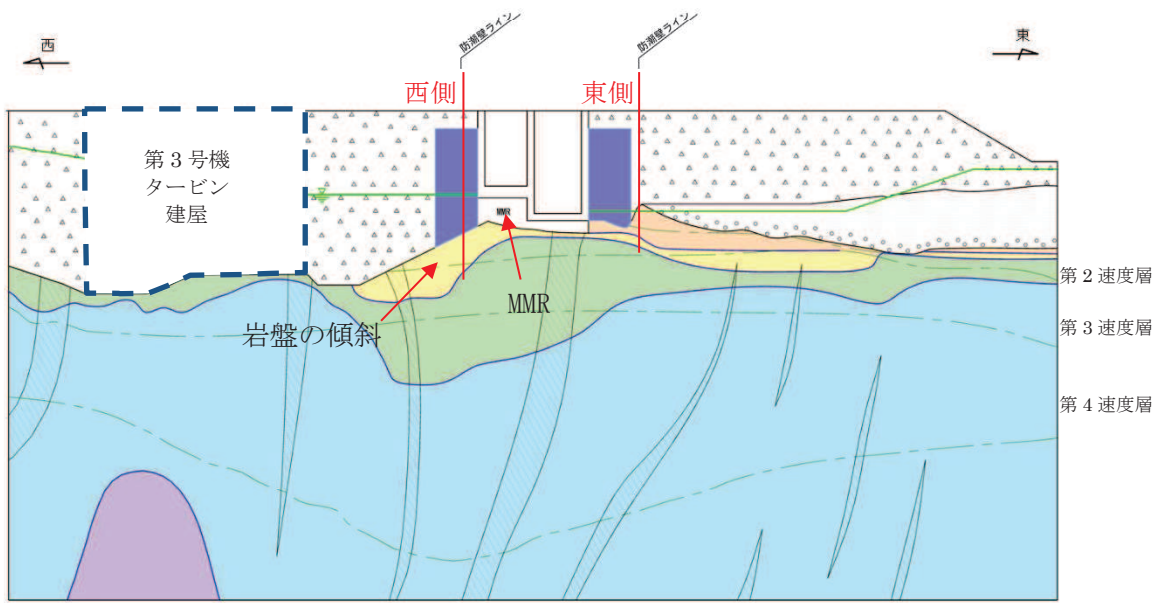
第3号機放水立坑地質断面図 (A-A断面)
